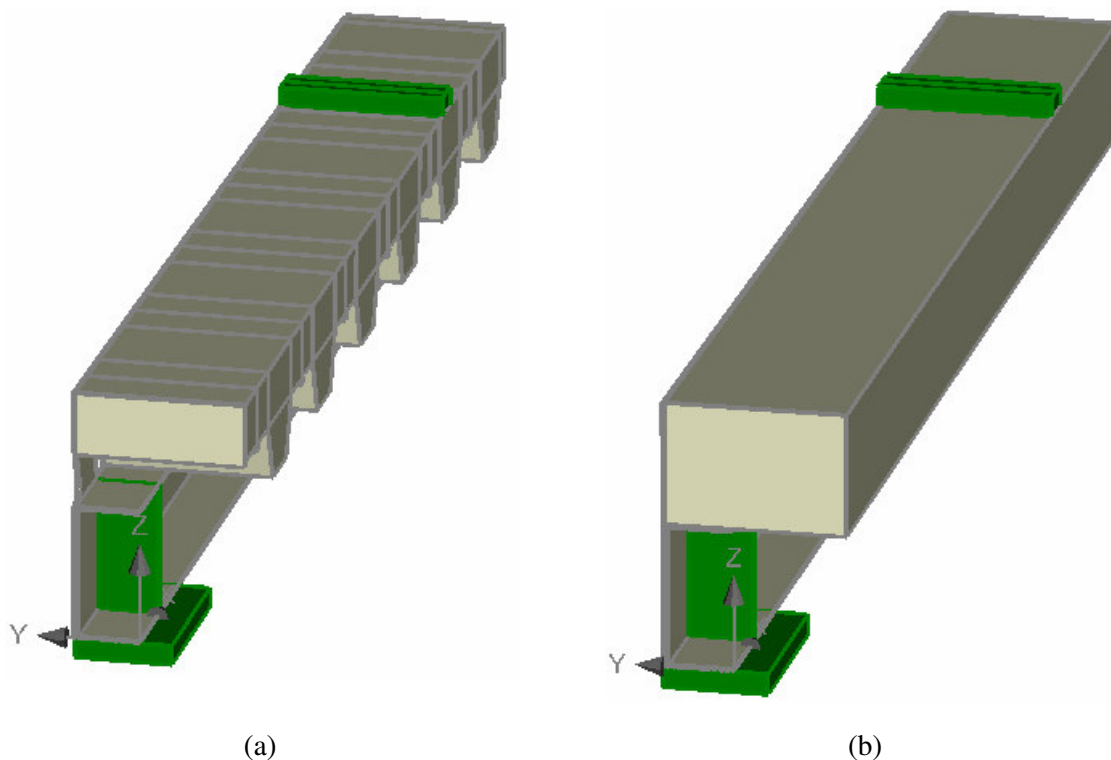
Geometria das chapas metálicas no *Software ATENA 3D*: (a) Viga mista com laje de betão nervurada; (b) Viga mista com laje de betão maciça.
